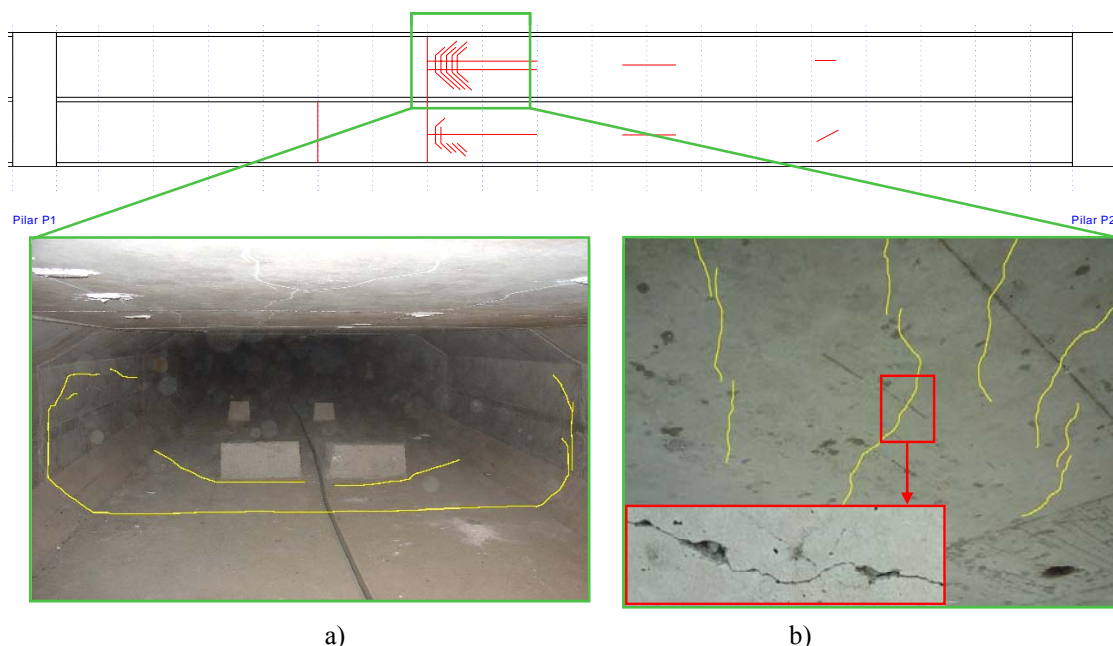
Fissuração típica da laje inferior: a) vista do interior do caixão (face superior da laje); b) vista do exterior (face inferior da laje).
